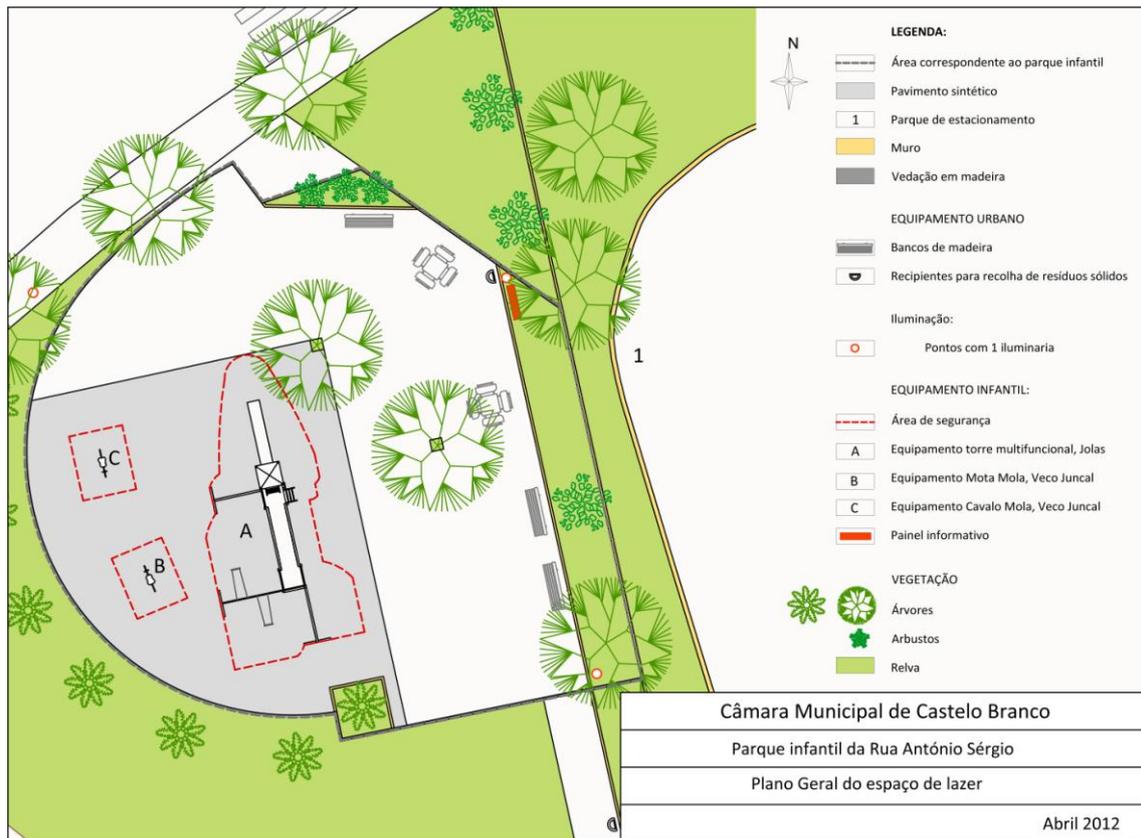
Planta do parque infantil da Rua António Sérgio. (Planta elaborada pela autora)
